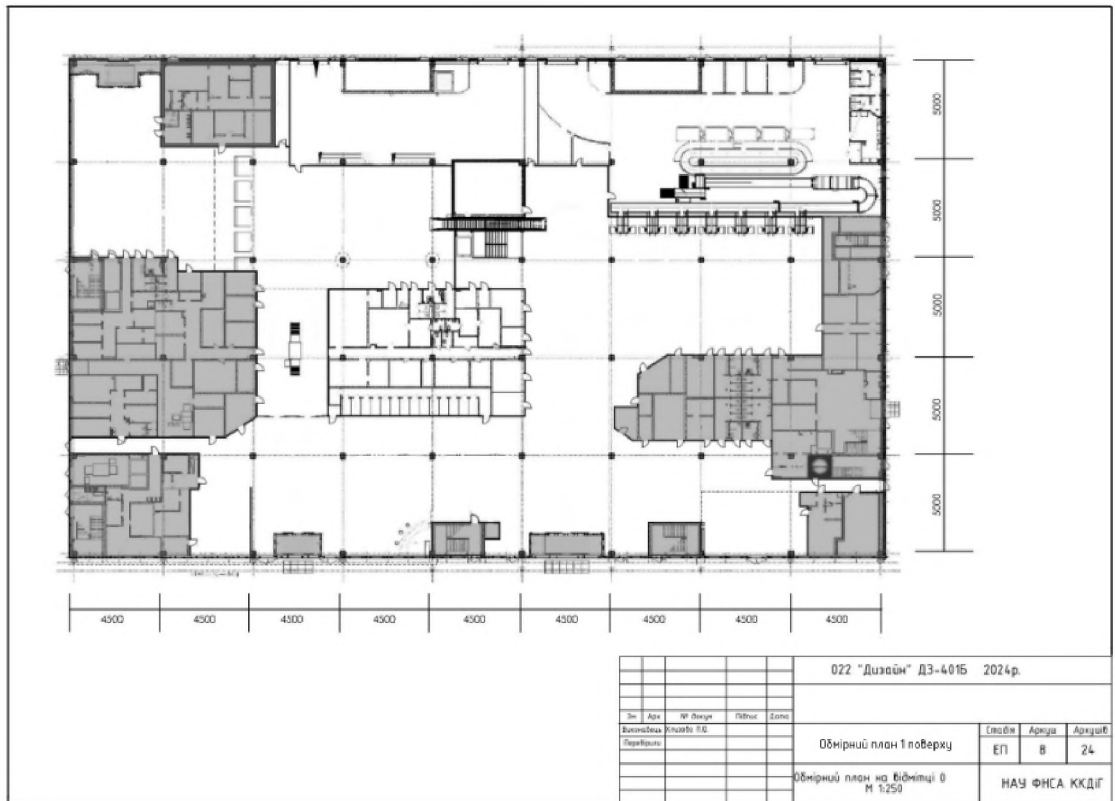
Вихідні дані: планування першого поверху аеровокзалу "Київ". Генплан
